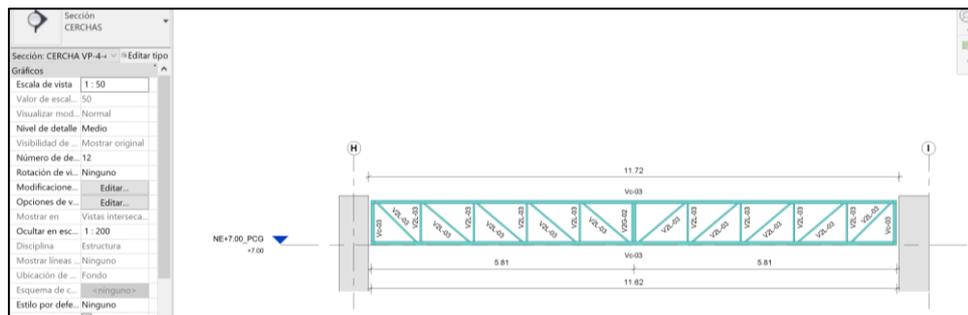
sección de viga eje 6, modelo estructural Industrial BIM
